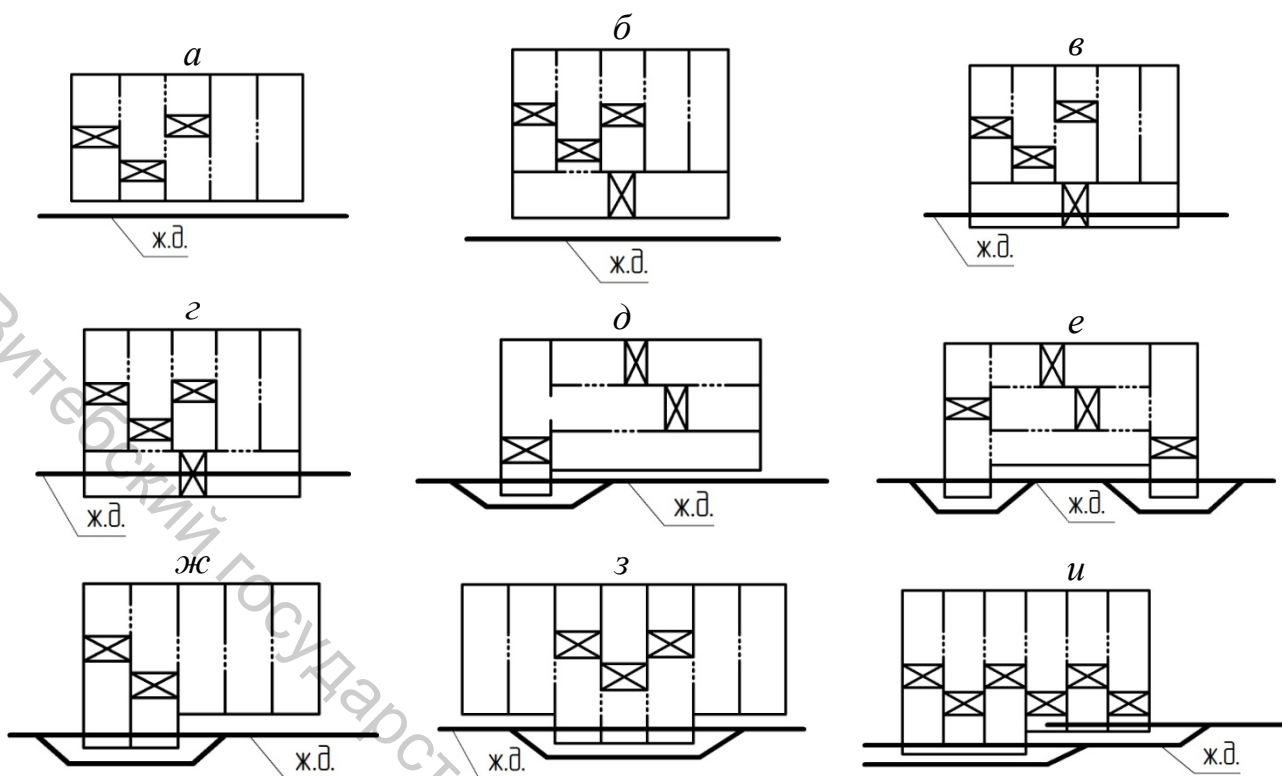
Схемы расположения железнодорожного пути: а – снаружи здания перпендикулярно к продольной оси пролётов; б – снаружи здания параллельно к продольной оси пролёта; в – внутри здания параллельно продольной оси пролёта вдоль внутренней стены; г – внутри здания параллельно продольной оси пролёта посередине пролёта; д – внутри здания перпендикулярно к продольной оси одного пролёта; е – внутри здания перпендикулярно к продольным осям двух крайних пролётов; ж – внутри здания перпендикулярно к продольным осям двух смежных пролётов; з – внутри здания перпендикулярно к продольным осям трёх пролётов; и – внутри здания перпендикулярно к продольным осям всех пролётов
